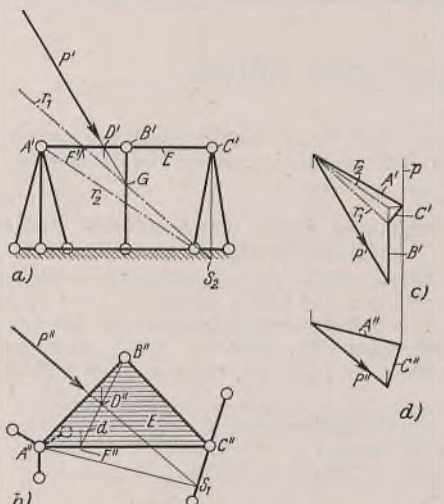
a u. b. Auf- und Grundriß des Fachwerks. Bild 2 c u. d. Kräfteplan für Auf- und Grundriß.
